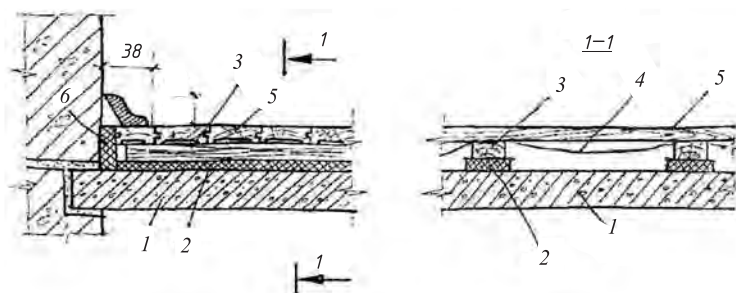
Полы дощатые: 1 — плита перекрытия; 2 — звукоизоляционная ленточная прокладка; 3 — лага; 4 — пергамин; 5 — шпунтованные доски; 6 — звукоизоляционная прокладка у стены; 7 — деревянный плинтус
